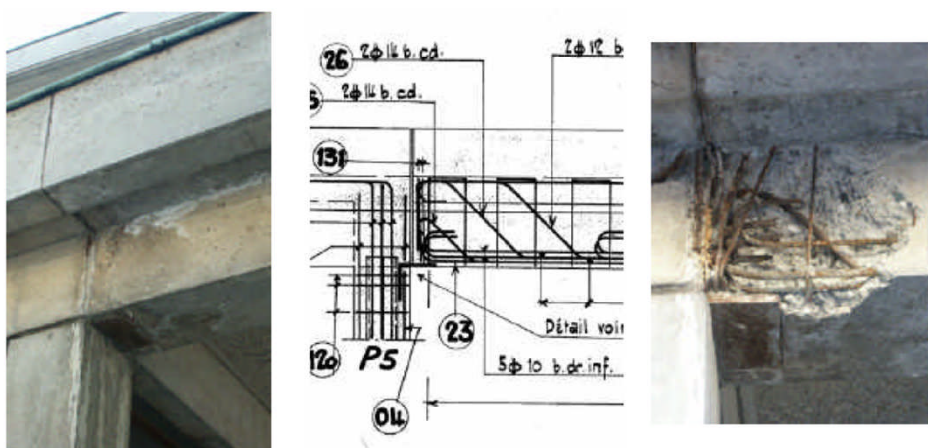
Fissuration et désagrégation du béton sur appui en raison de mauvaises dispositions constructives (ESM - Sarrasin Ingénieurs SA)
